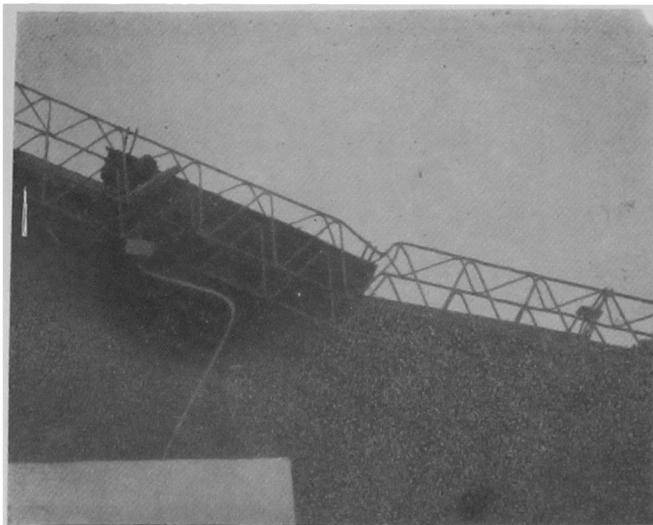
Daños en un galpón construido con barras redondas soldadas. La Galera
